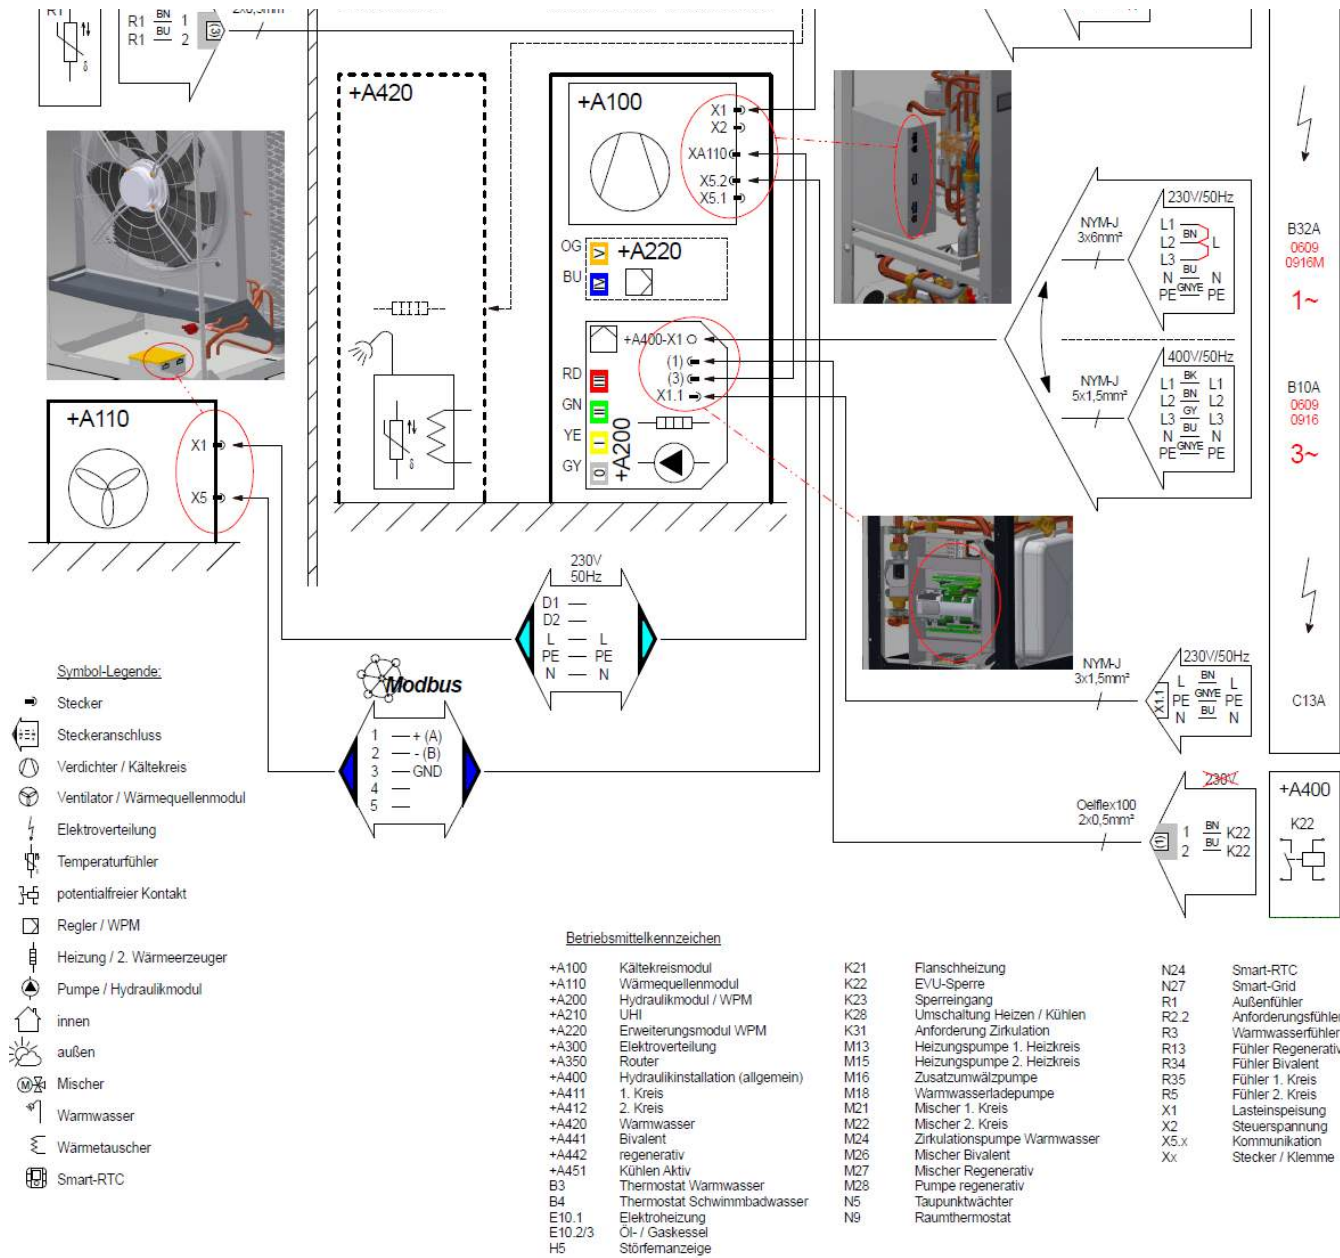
Plan de raccordement M Flex 0609 (230V), 0916 (M) (230 / 400V)
